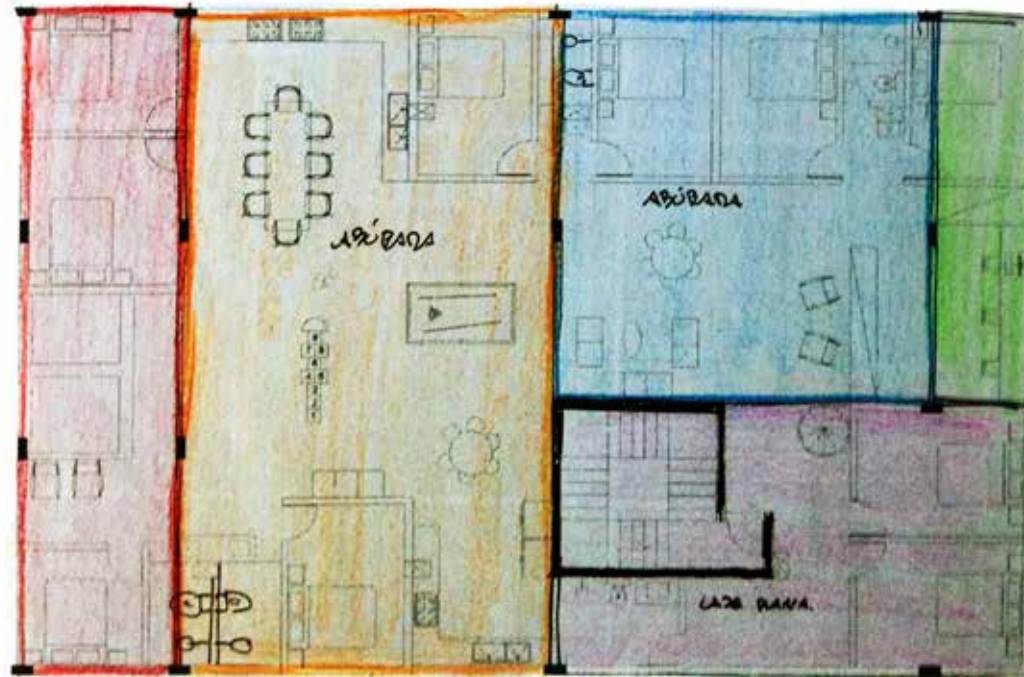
Planta e corte do pavimento tipo com destaque para as áreas com estrutura de laje plana e as áreas com estrutura em abóbadas.
